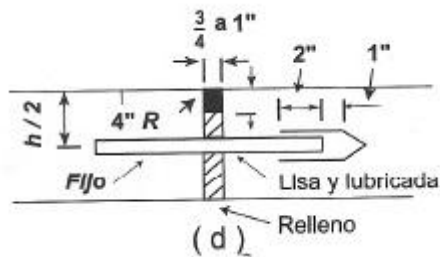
b.18 Junta de expansión con dispositivo de transferencia.
